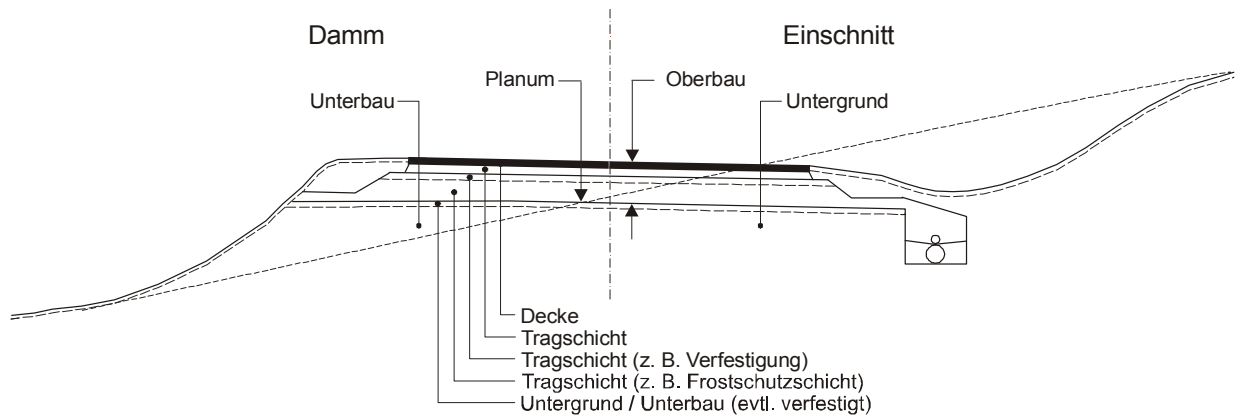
Beispielhafter Aufbau einer Befestigung - Damm/Einschnitt [1]
